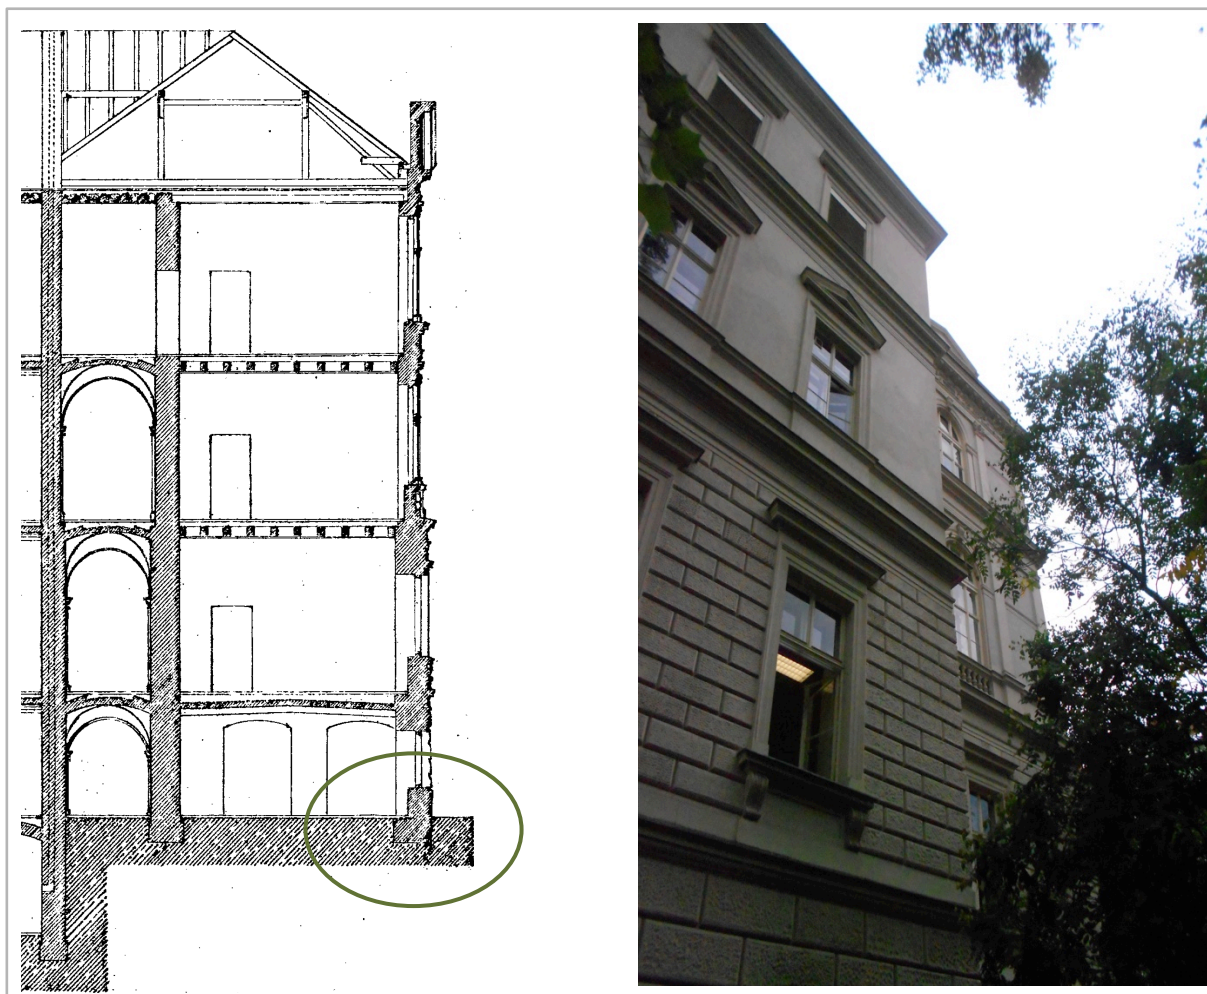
Plandarstellung des Fundamentbereichs der Alten Technik [Plan aus TUG-Archiv]
